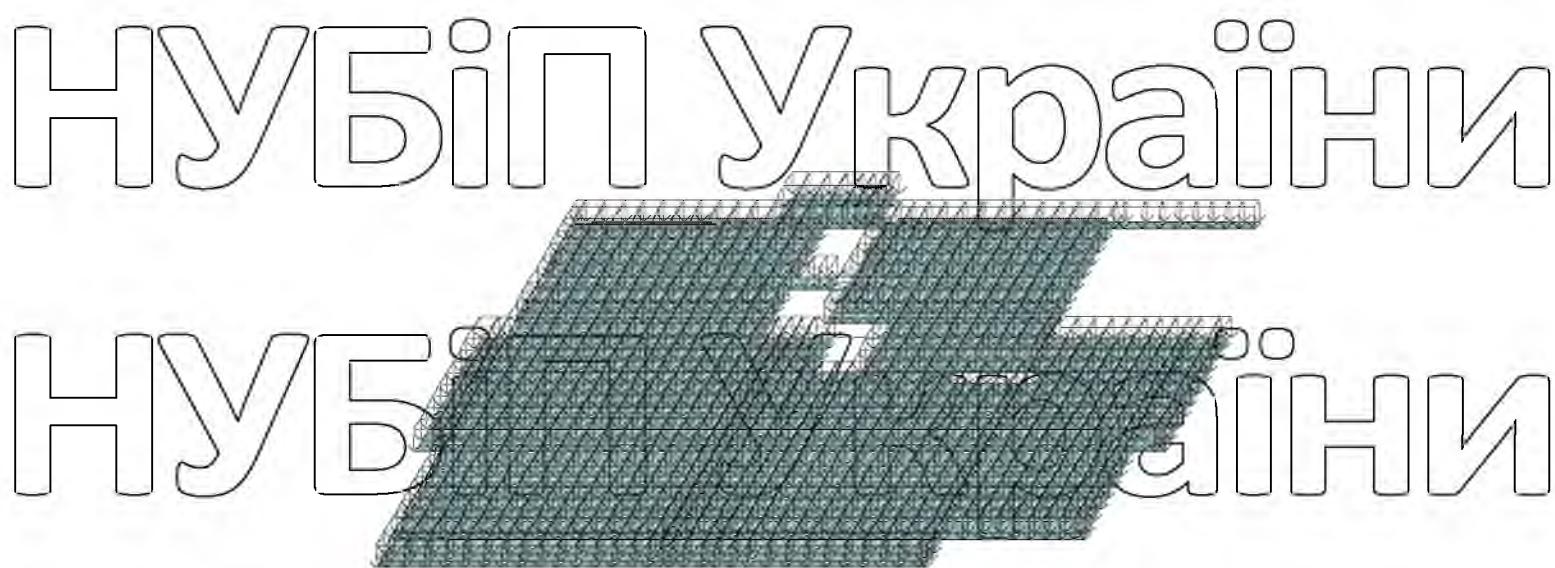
Навантаження на плиту перекриття над підвалом
